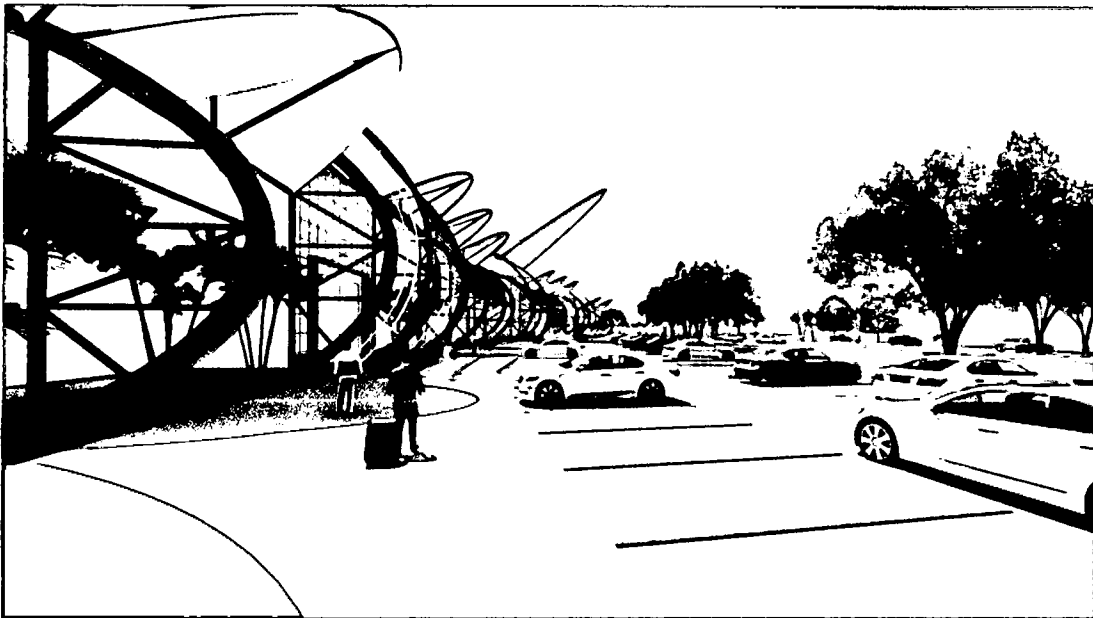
Alzado vista desde la via d evitamiento
